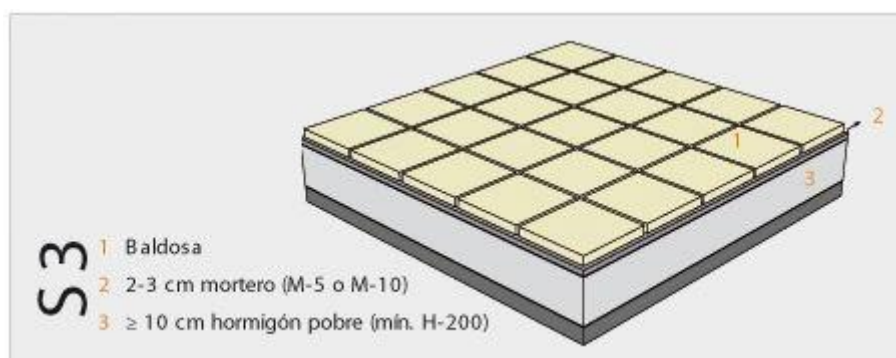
Subbase sobre la que se apoya el pavimento. Fuente: Pavimentos graus.
